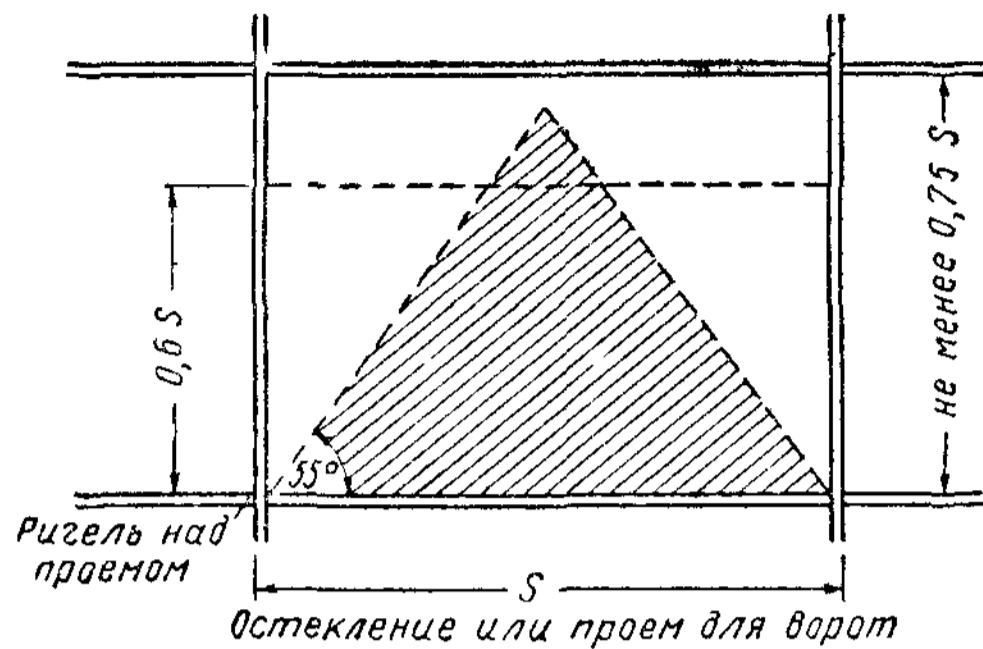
Расчетная нагрузка на ригель, расположенный над проемом при подвесном ограждении
